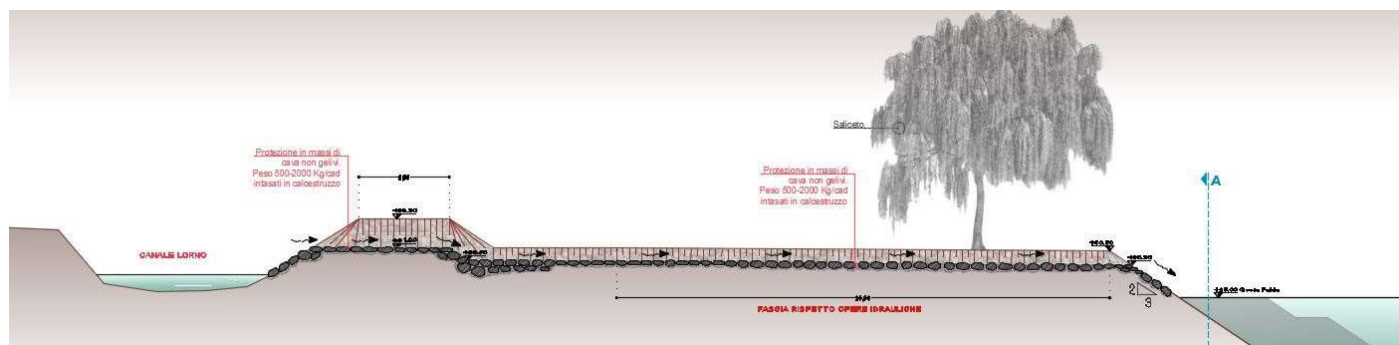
Manufatto di ingresso canale Lorno: sezione.
